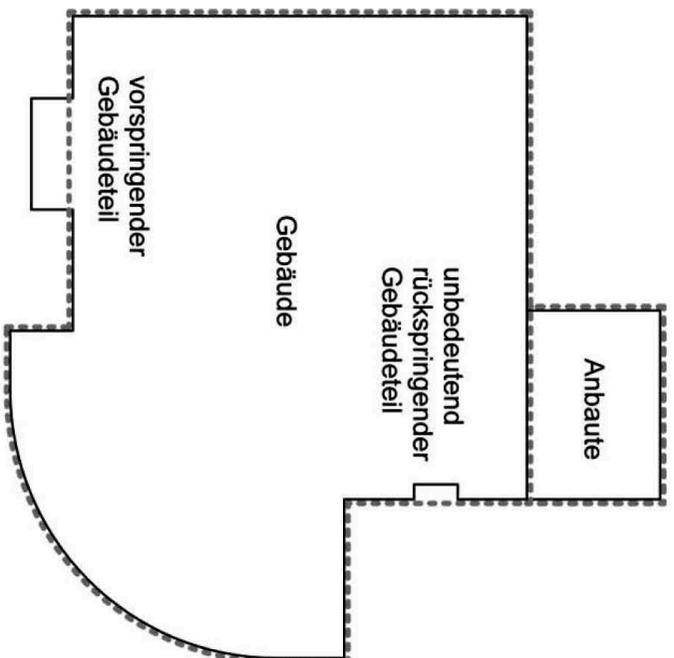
Gebäude, Anbauten und Kleinbauten
